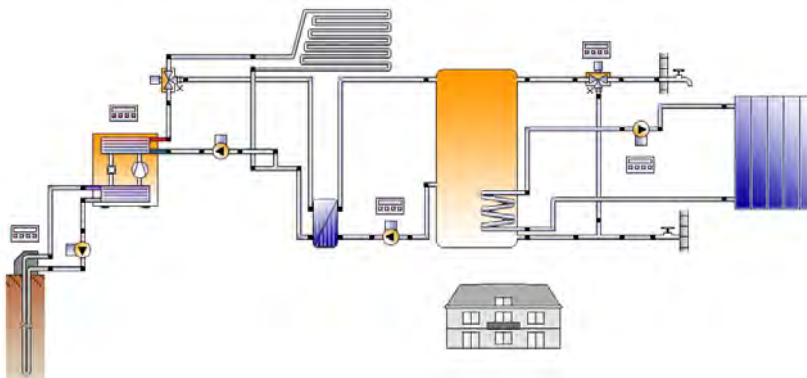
System mit Sole-Wasser Wärmepumpe und Solarkollektoren, siehe auch [6]
